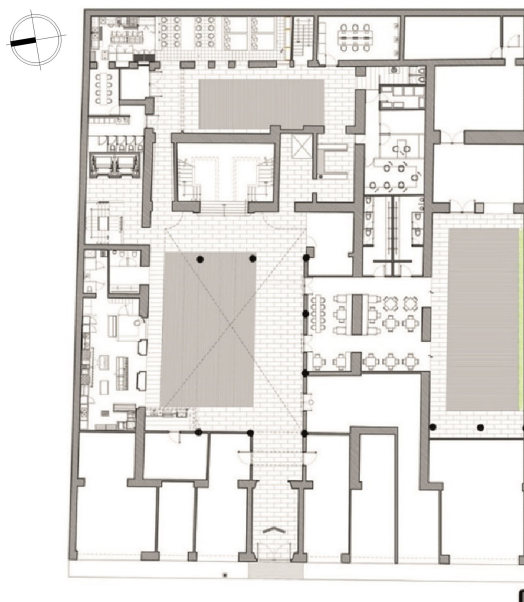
Planta baja del proyecto. Fuente: Plataforma Arquitectura
